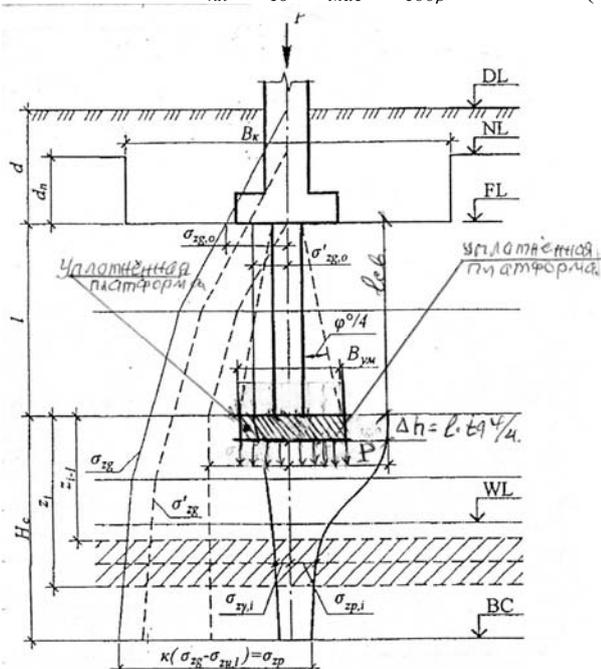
Расчетная схема к расчету осадки свайного фундамента с учетом уплотненной платформы
